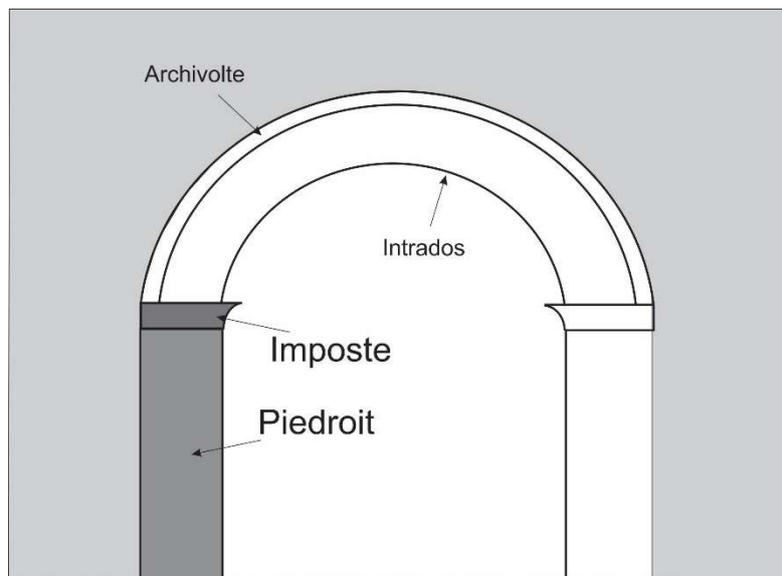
Arc reposant sur un piédroit, via une imposte.
